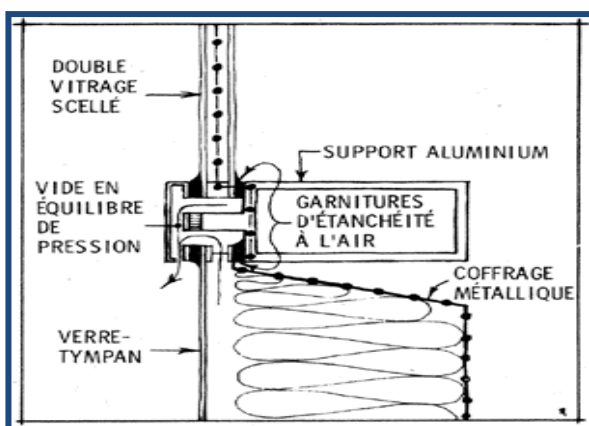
coupe d'un mur rideau<sup>97</sup>
